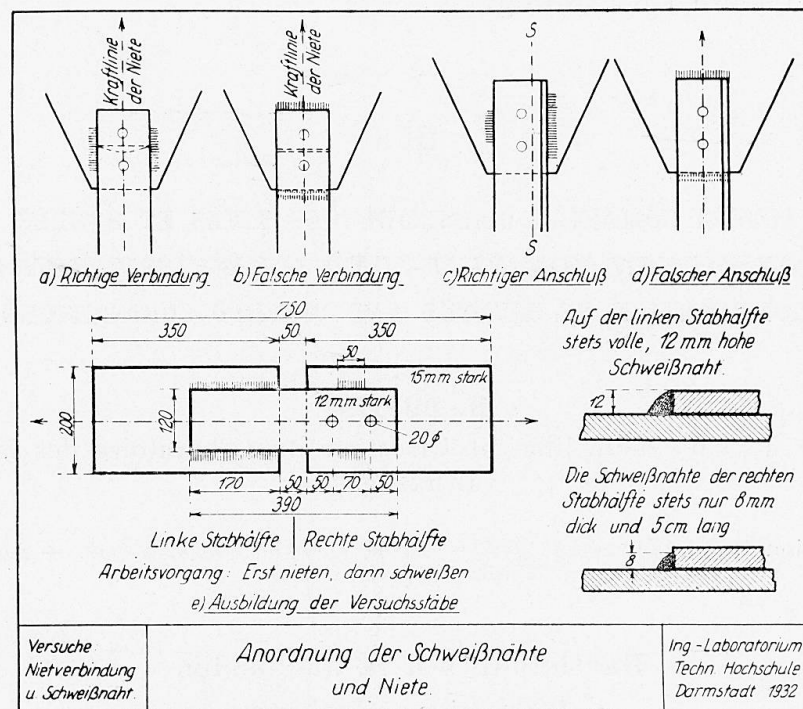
Disposition des cordons de soudure et des rivets
